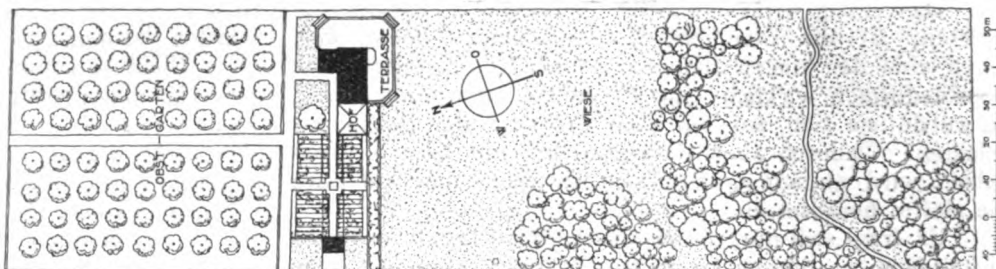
Haus Plesch bei Hamburg. Arch. H. Muthesius. — Lageplan 1:2000 (Grundrisse auf S. 197).
